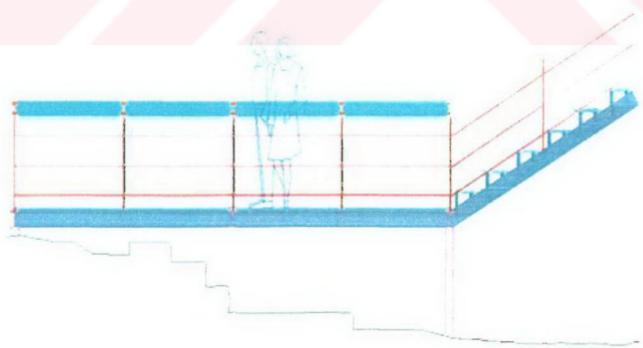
Gezi Güzergah Platformu Model Planı
